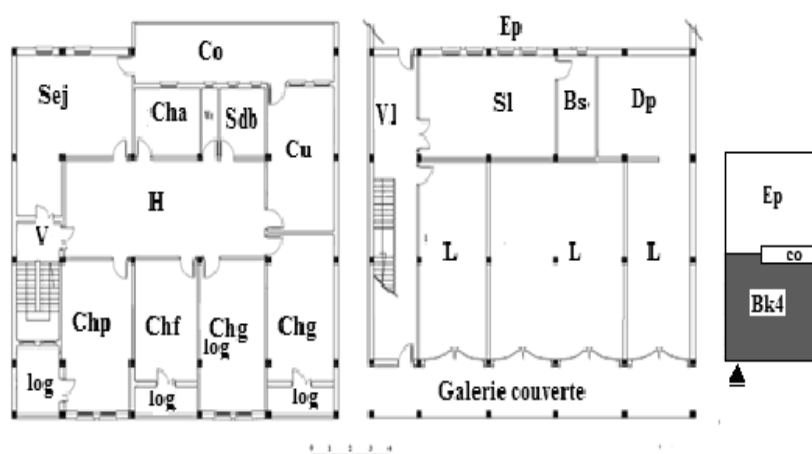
Plan rez de chaussée et étage de l'habitation Bk4
